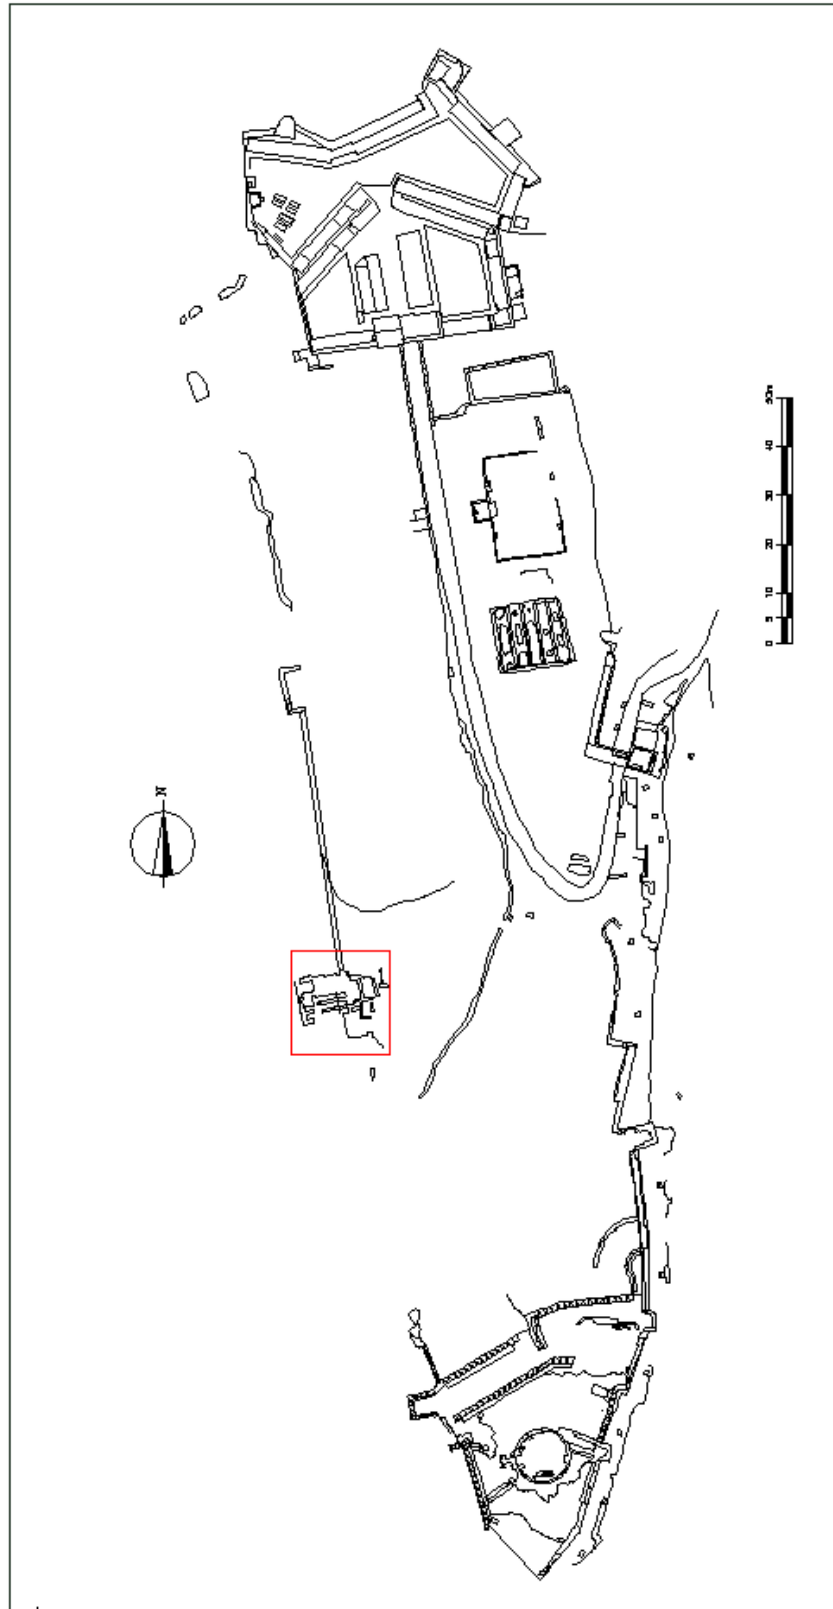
Planimetría general del castillo y detalle del área intervenida.
